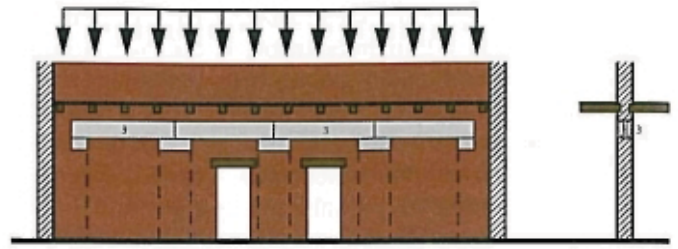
Integration vorhandener Stahlträger in einen neuen Stahlbeton-Unterzug
